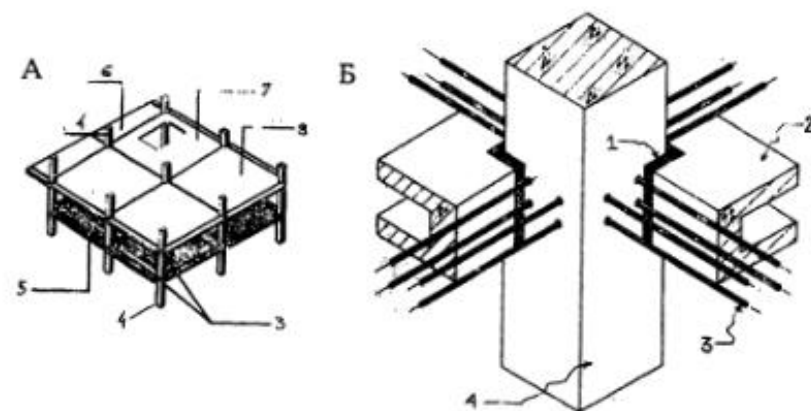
Безригельный каркас с натяжением арматуры в построечных условиях: А - компоновка узла примыкания плит перекрытия и пропуск арматуры через колонну; Б - схема компоновки несущих конструкций; 1 - уголкового вкладыш; 2 - плита перекрытия; 3 - натягаемая канатная арматура; 4 - колонна; 5 - фасадная распорка; 6 - консольная плита перекрытия; 7 - плита перекрытия с проёмом для лестницы; 8 - типовая плита перекрытия
